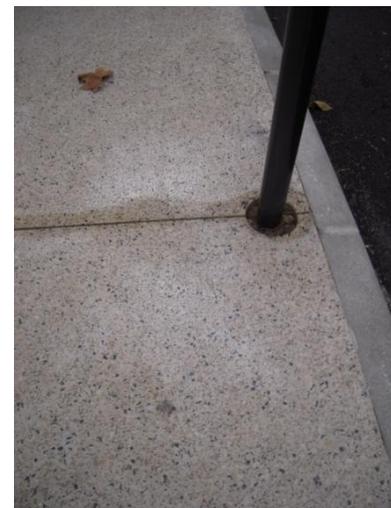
Dans le cas de ce poteau de signalisation verticale sur un trottoir en béton, il n'y a pas eu de réservation mais carottage au-dessus de sa fondation et de l'arrivée de son alimentation électrique. Le calepinage a localisé un joint de retrait au droit de ce carottage pour éviter une fissure.
